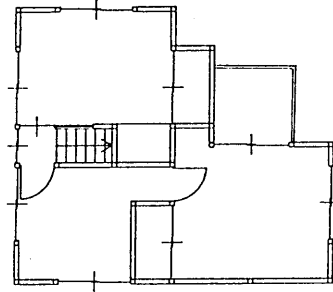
解析対象建築物平面図 (No.27, No.28)
